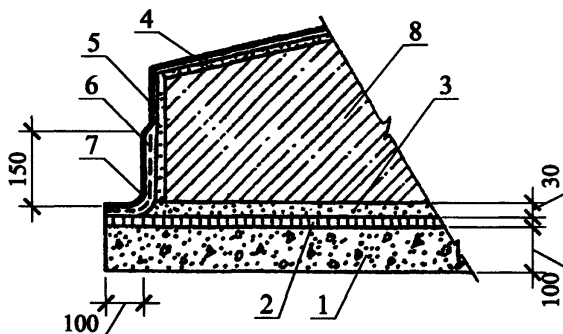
Узел 7. Литая и окрасочная гидроизоляция
